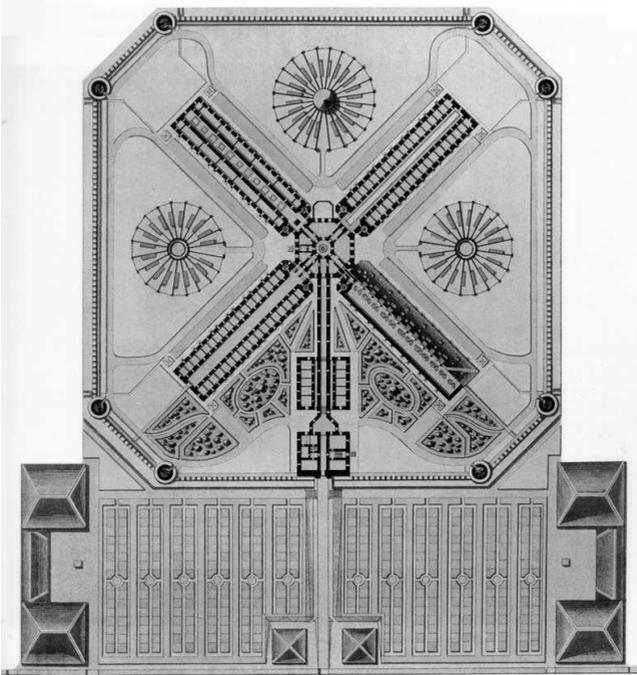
Strafanstalt in Bruchsal. 1841-1848. Architekt: Johann Heinrich Hübsch. Lageplan mit vorgelagerten Beamtenwohnhäusern. Innerhalb der Gefängnismauer die Zellentrakte, die Spazierhöfe mit Grünanlagen und der Eingangsbau mit Krankenstation. Die Grundrisse der Zellentrakte zeigen vom Eingangsgebäude beginnend im Uhrzeigersinn: 1. Das Erdgeschoss, 2. Das Souterraingeschoss mit Heizanlage/Öfen und Arbeitszellen, 3. Das erste und zweite Obergeschoss, 4. Den Speicher und eine Dachaufsicht. Aus: [SJD98], S. 32.
